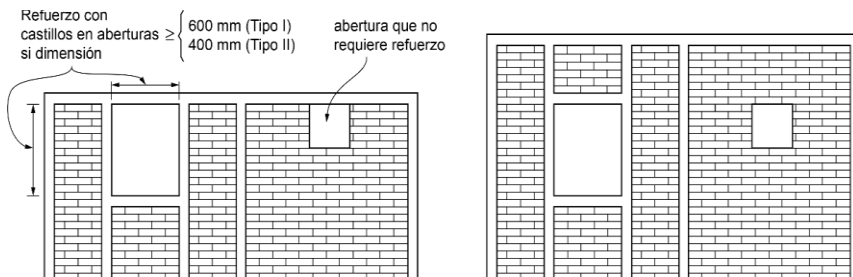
Refuerzo en el perímetro de aberturas
